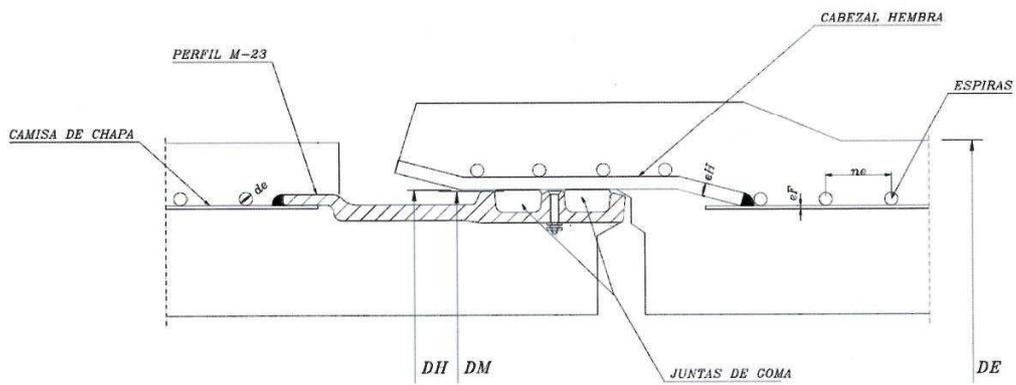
Junta elástica doble en tubería de hormigón postesado con camisa de chapa.
